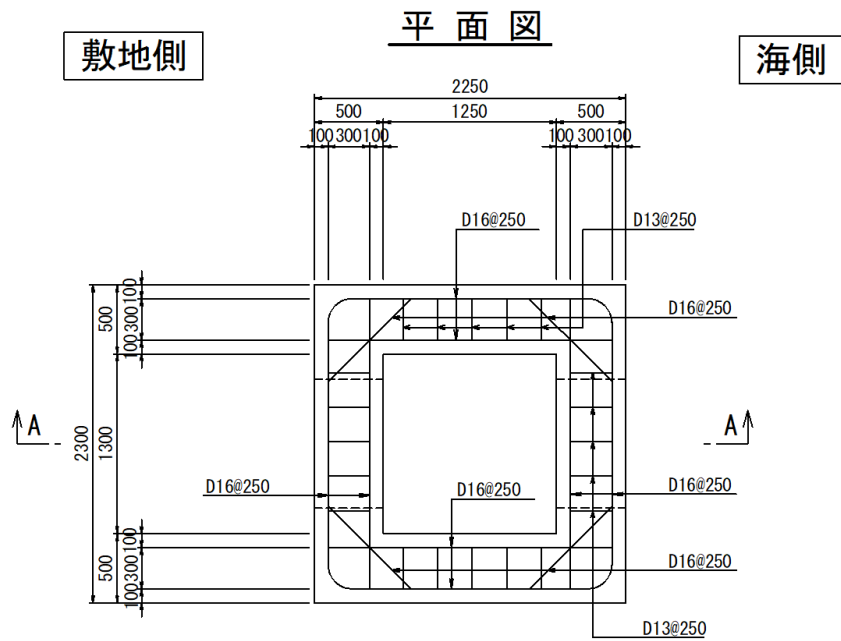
(6) 概略配筋図 (集水桝 (屋外排水路逆止弁⑨))
